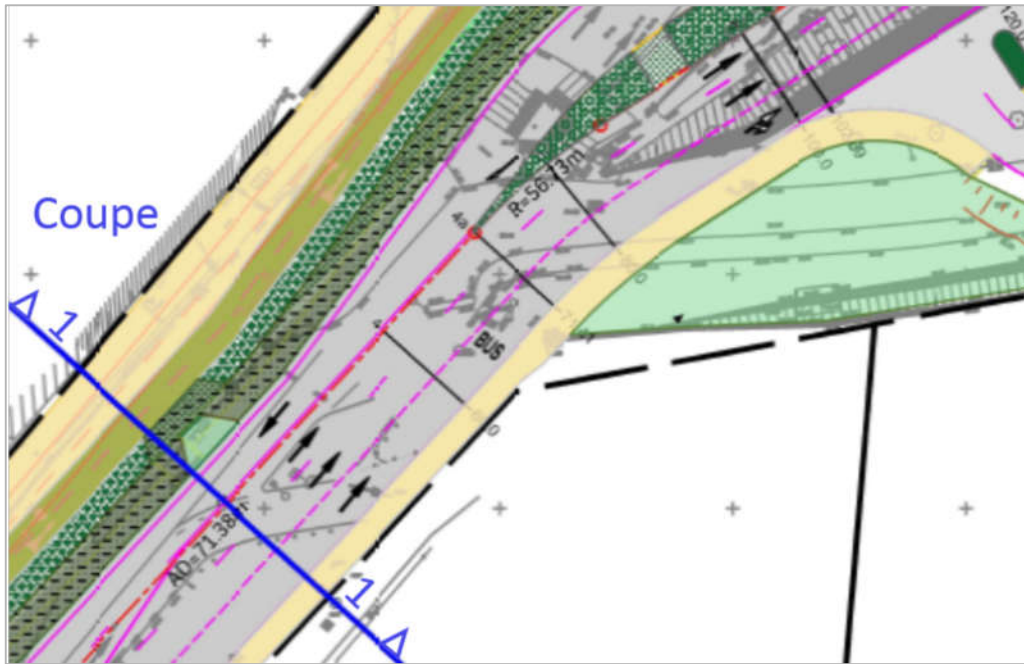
Tracé en plan optimisé par la suppression d'une voie sur le boulevard Anatole France devant l'école
